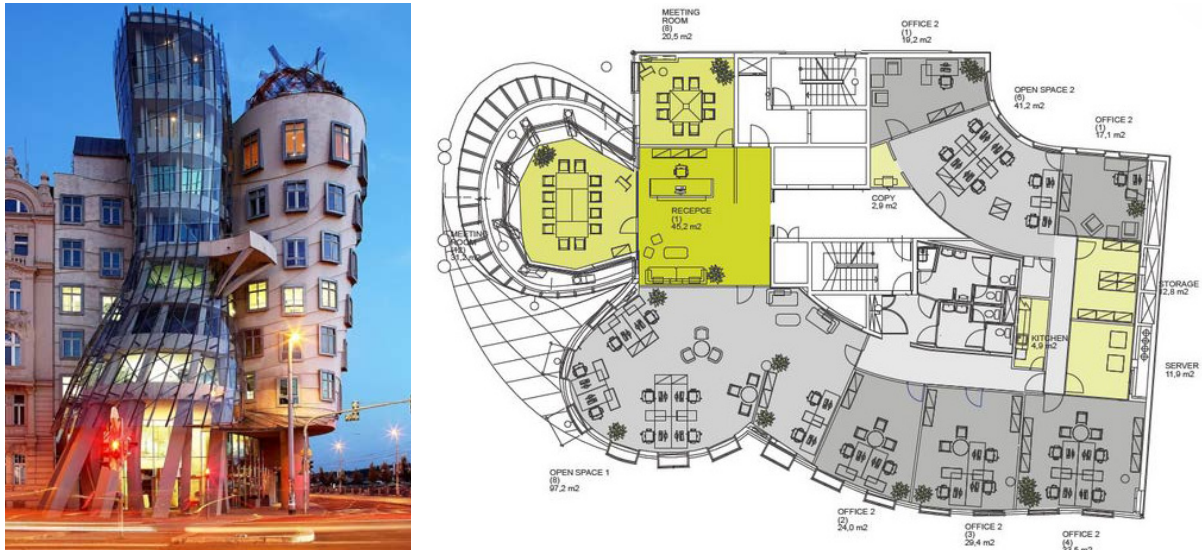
Ejemplo de irregularidad en planta y alzado: la Casa Danzante de Frank Gehry.
